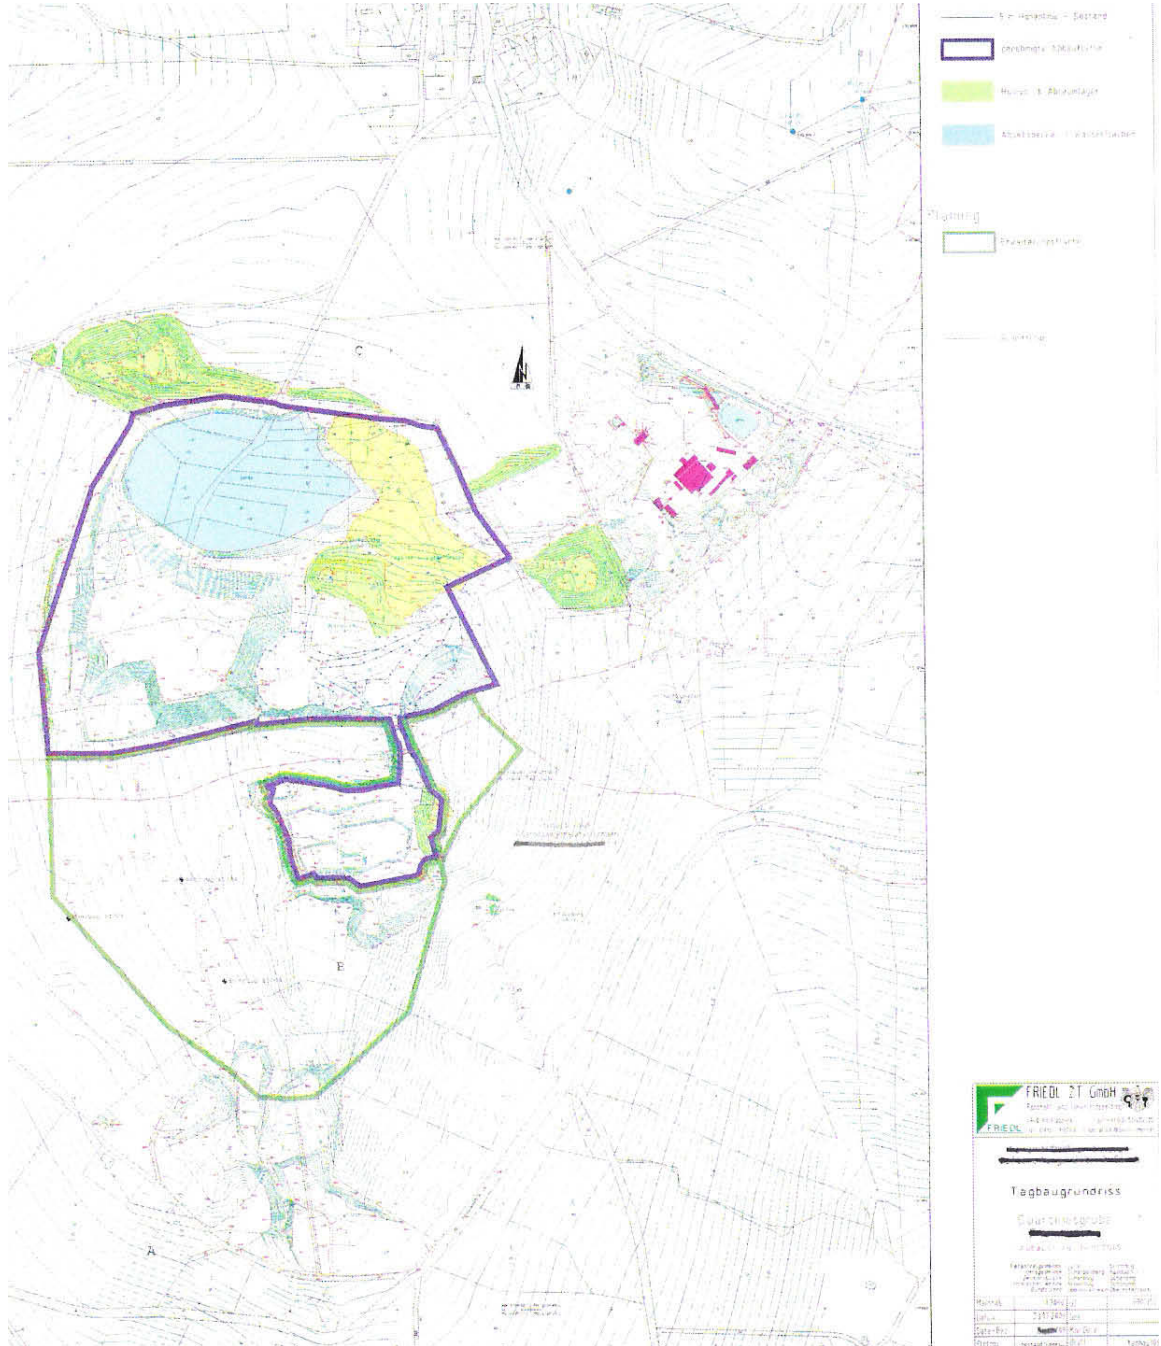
Lageplan nach § 80 MinroG (Tagebaugrundriss)
